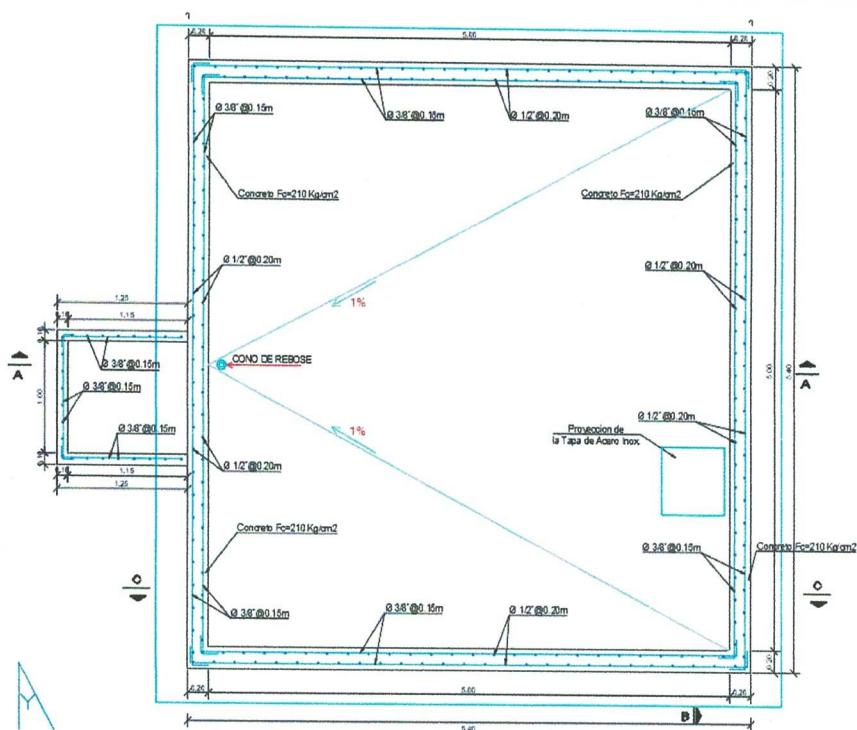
Detalle en perfil de las arquitecturas del reservorio de 40 m<sup>3</sup>
